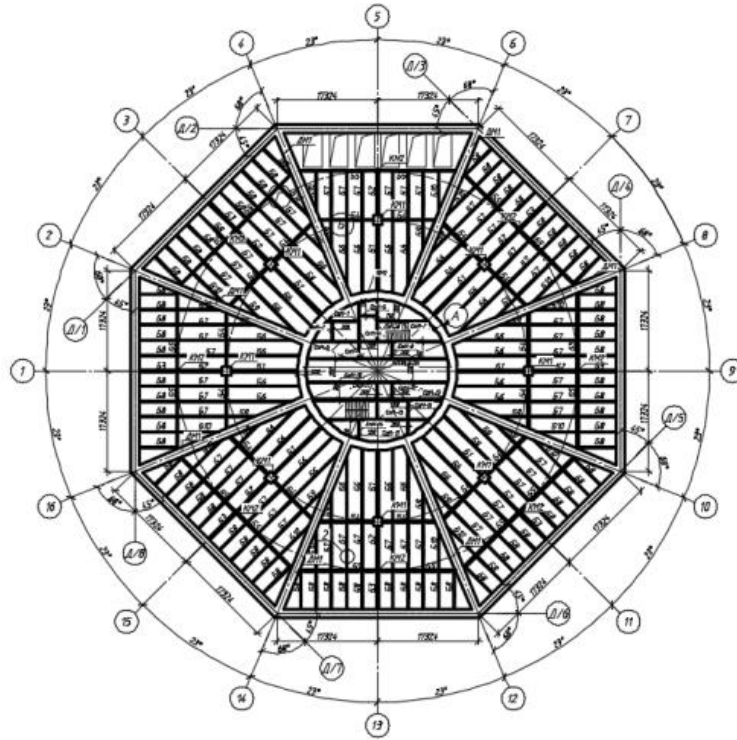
Конструктивна схема монолітного залізобетонного перекриття з профільованим настилом
